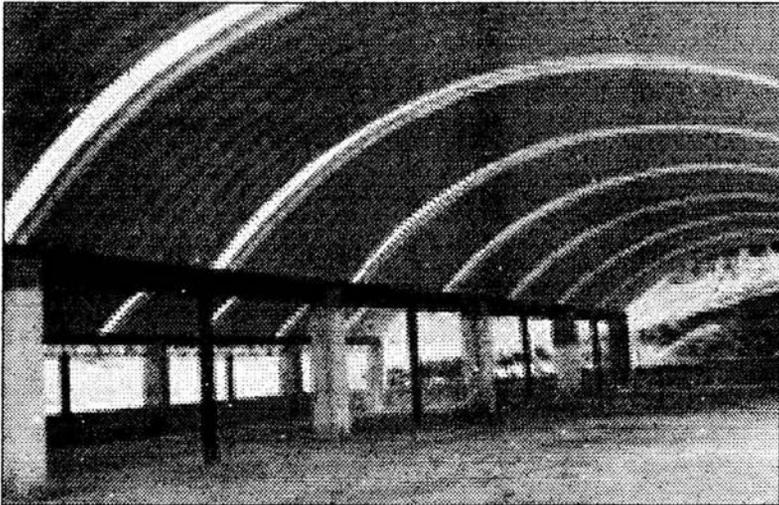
En la fotografía se muestra como ejemplo el uso de laminas metálicas prefabricadas, en este caso para cubierta de grandes claros de naves industriales.
